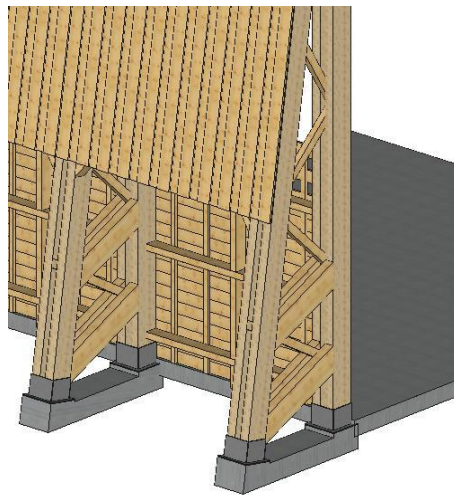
Détail des poteaux treillis vue de l'extérieur
